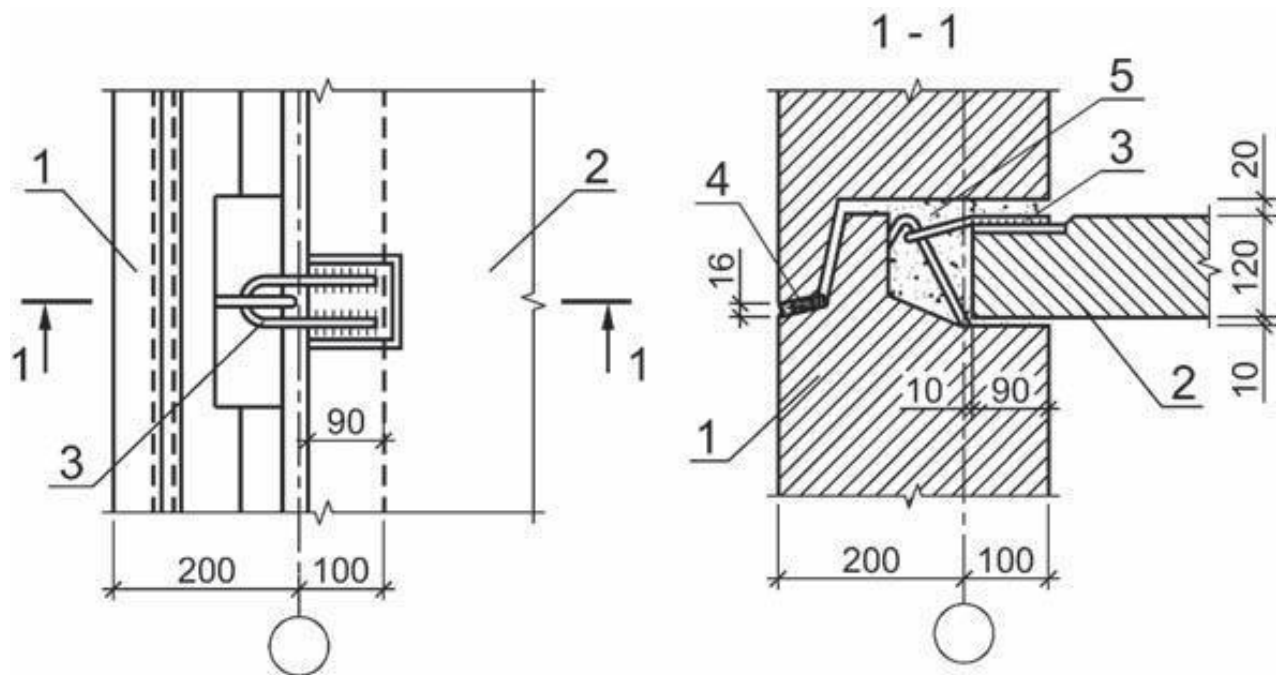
Вертикальный стык навесных наружных стеновых панелей с плитой перекрытия: 1 — стеновая панель; 2 — панель перекрытия; 3 — крепежная петля; 4 — упругая прокладка; 5 — утеплитель
